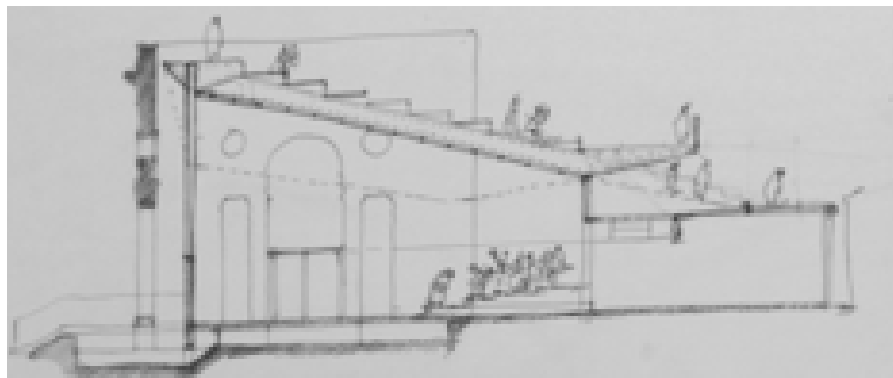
Sesta ipotesi di sezione trasversale tipo (AABS-948)
